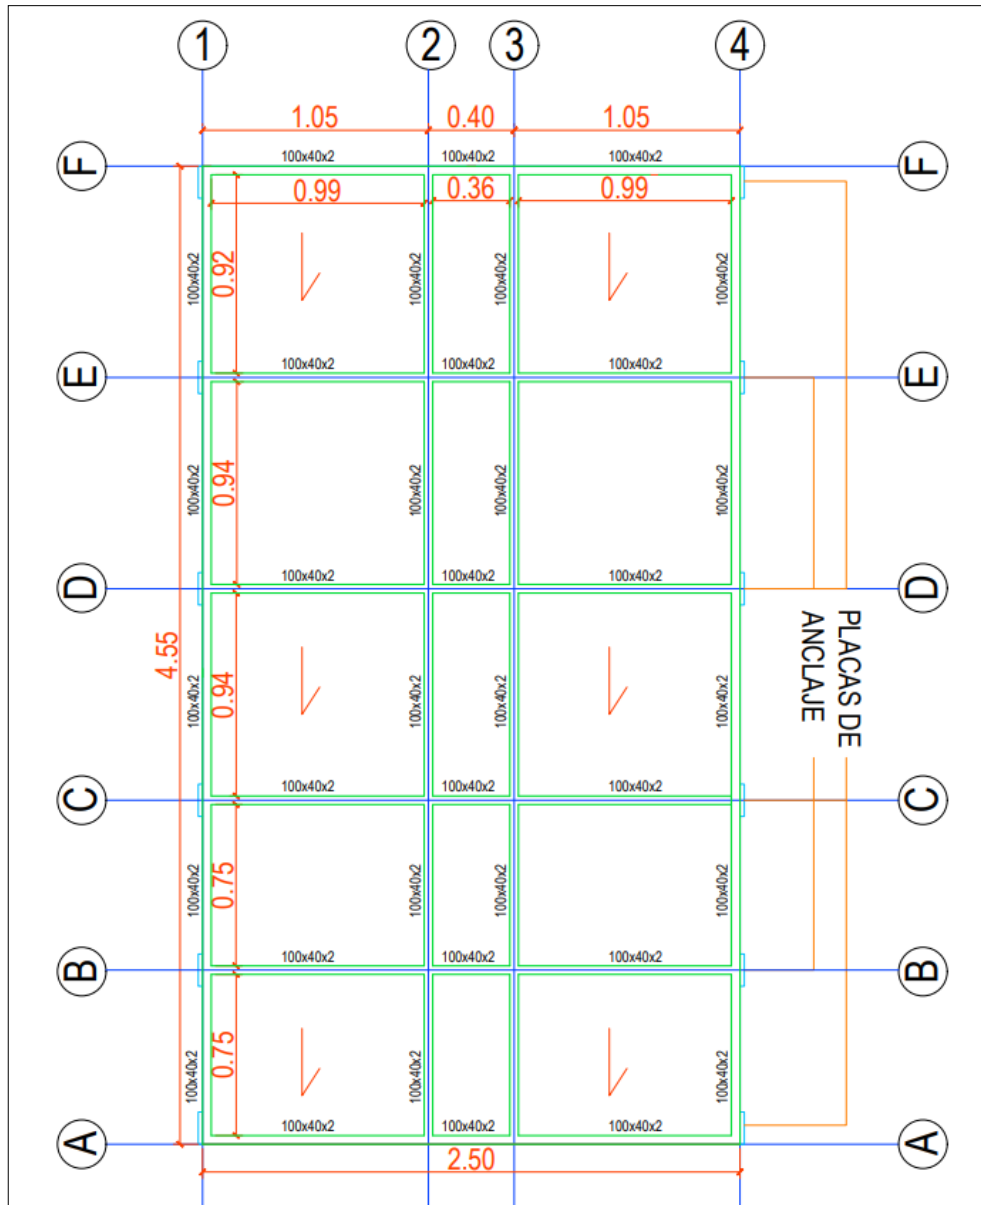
Tanque proyecto La Torre Páez, Cauca
